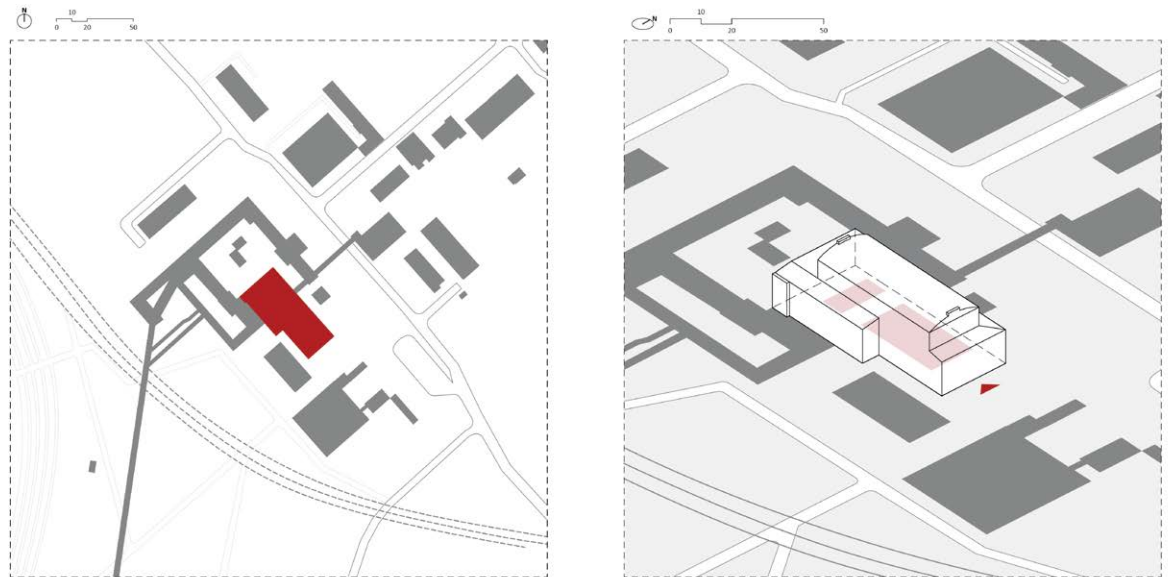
PACT Zollverein Essen, Bullmannau 20a, Lageplan und Isometrie mit Spielorten
